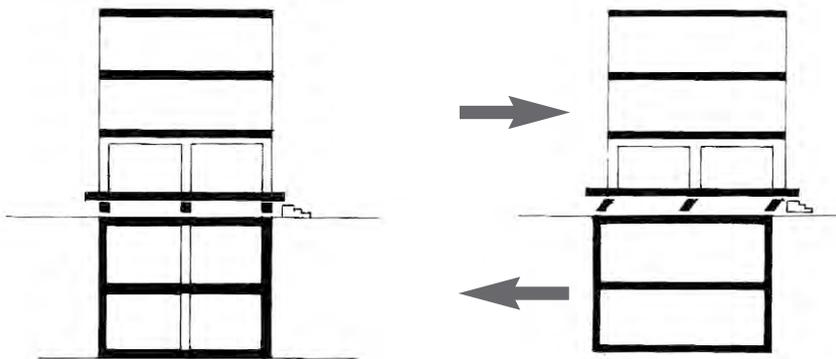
Utilisation de l'isolation parasismique. La superstructure devant osciller comme un bloc, une grille de poutres reliant les pieds de poteaux est nécessaire.
